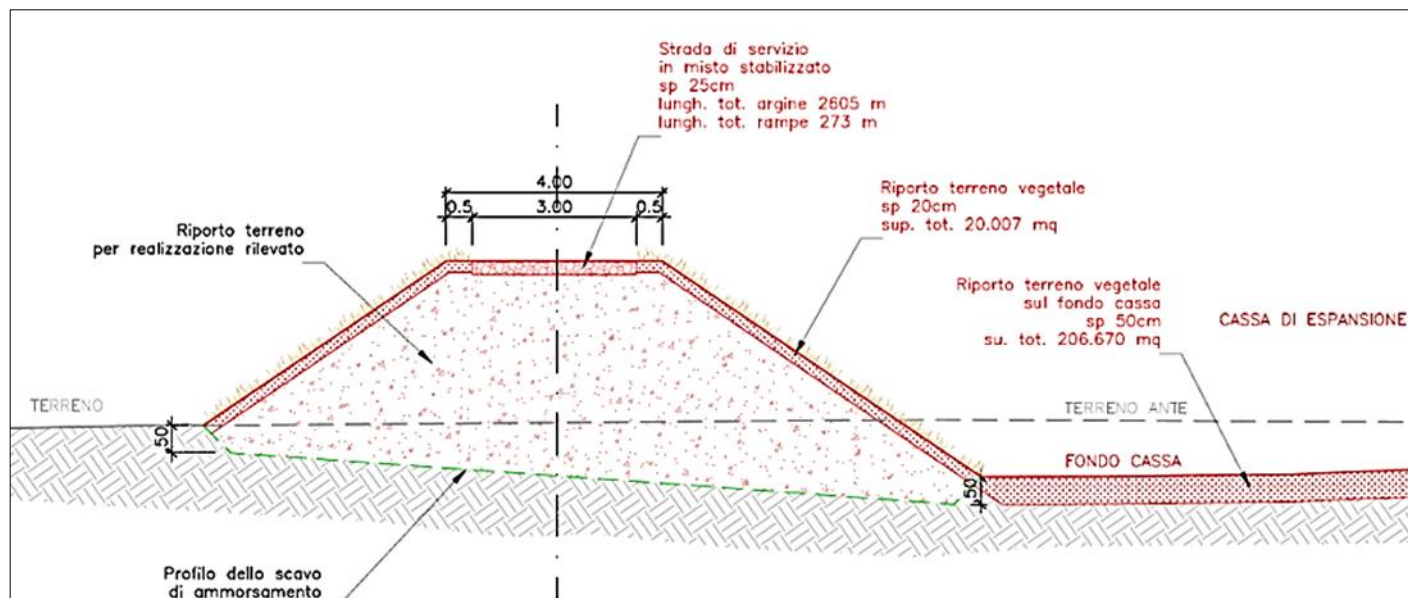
Sezione tipo strada di servizio in sommità del rilevato arginale
